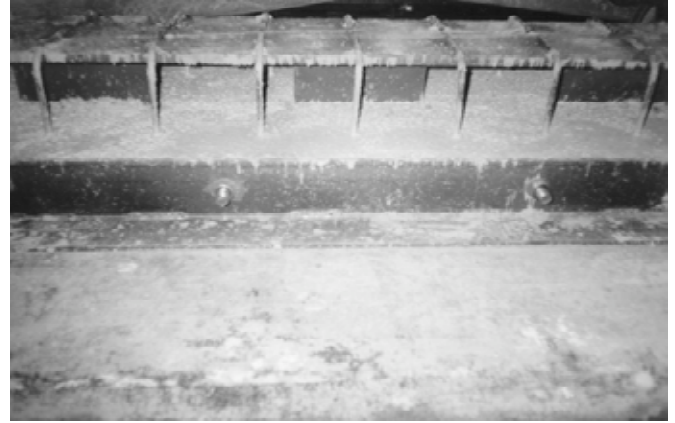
Jácena mixta hormigonada y comprimida con pasadores de barra roscada.
